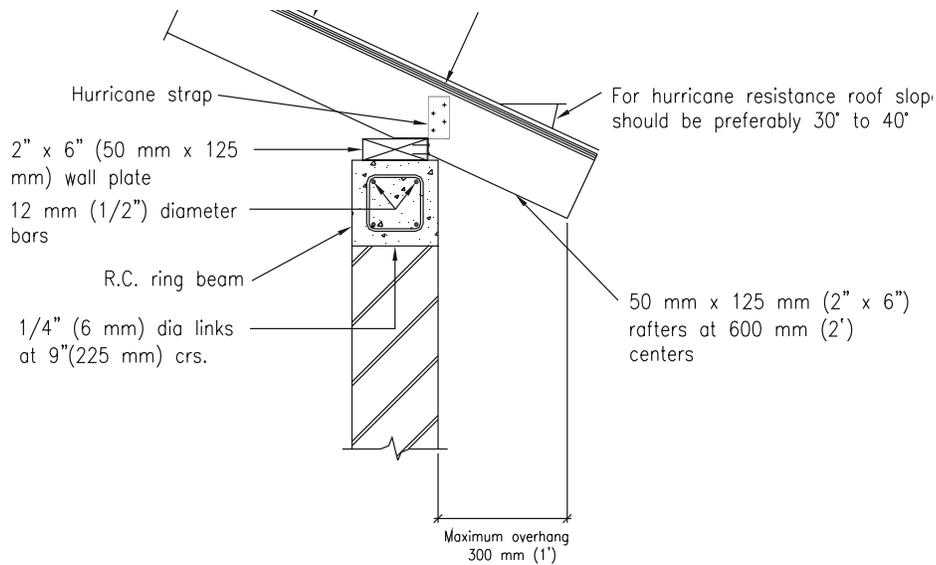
Détails d'assemblage du toit pour une toiture de 12 m de portée
